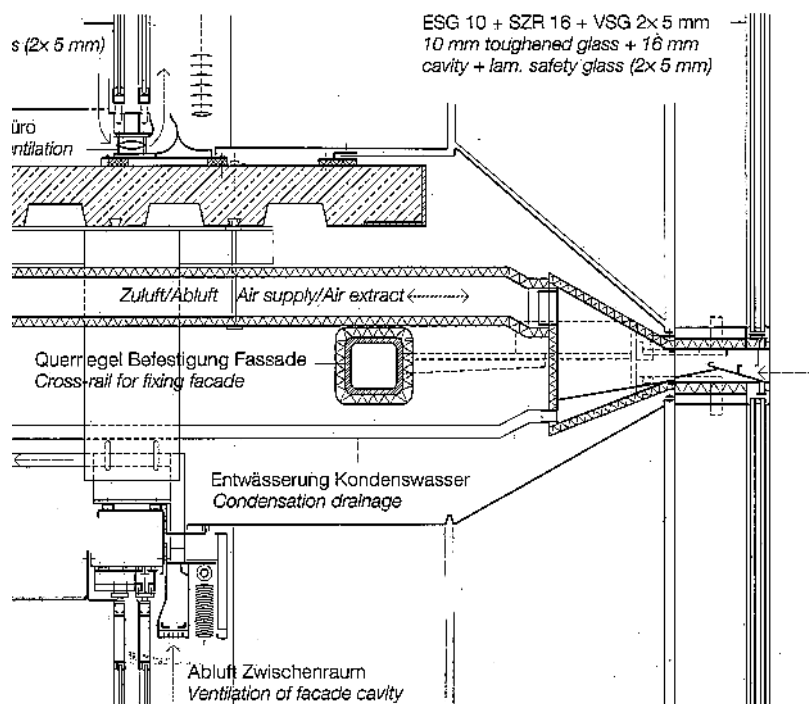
Сечение через оболочку: 1 – ламинированное безосколочное стекло (2×5 мм); 2 – усиленное стекло 10 мм + 16 мм воздушная полость + ламинированное безосколочное стекло (2×5 мм); 3 – офисная вентиляция; 4 – воздуховод; 5 – поперечный рельс для фиксации фасада; 6 – уплотняющий дренаж; 7 – вентиляция фасадной плиты
